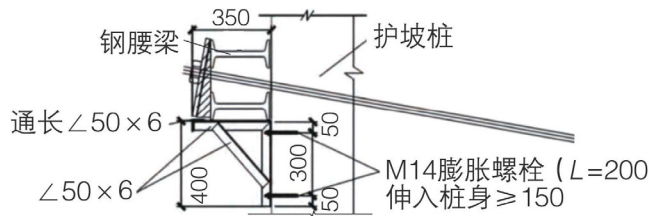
预应力锚索张拉锁定端头布置示意图 (mm)
